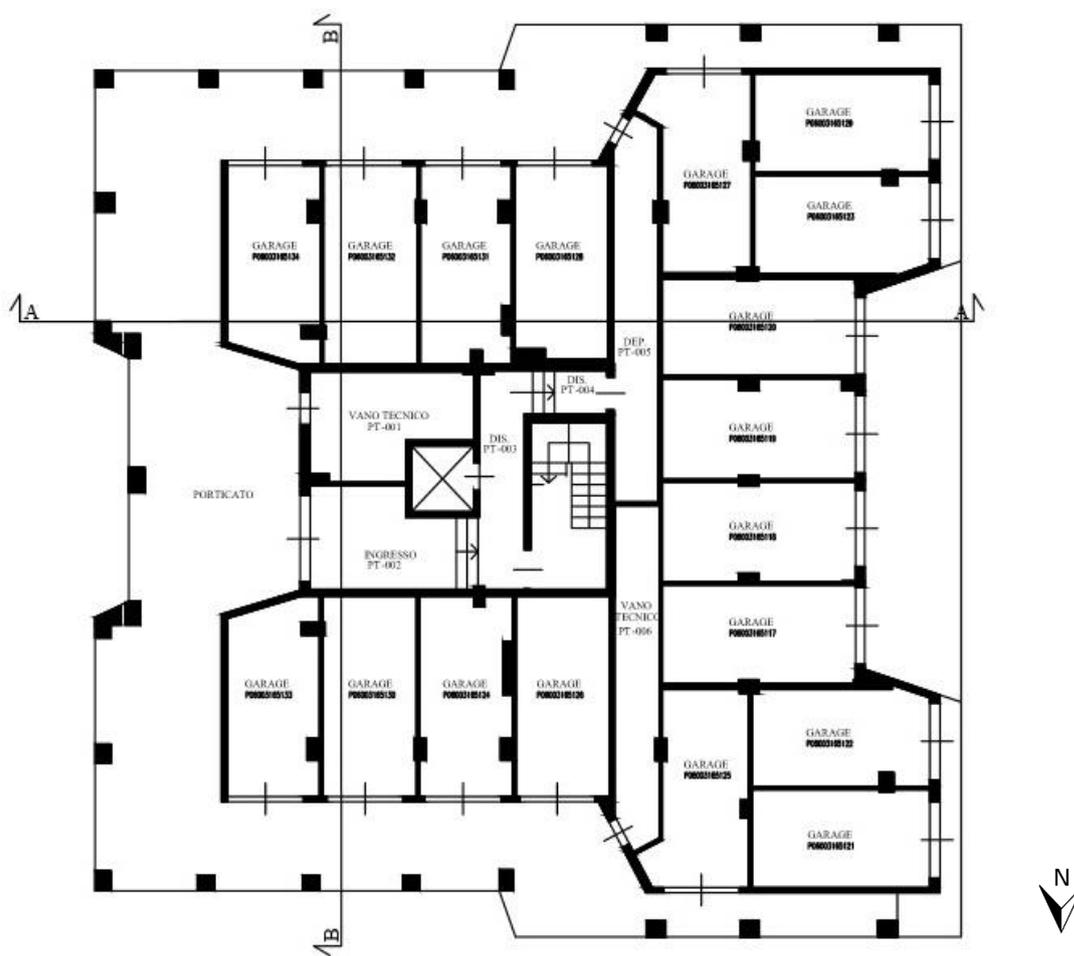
Pianta piano terra, via Brofferio 1. Scala 1:200. Fonte: Ater Padova.
